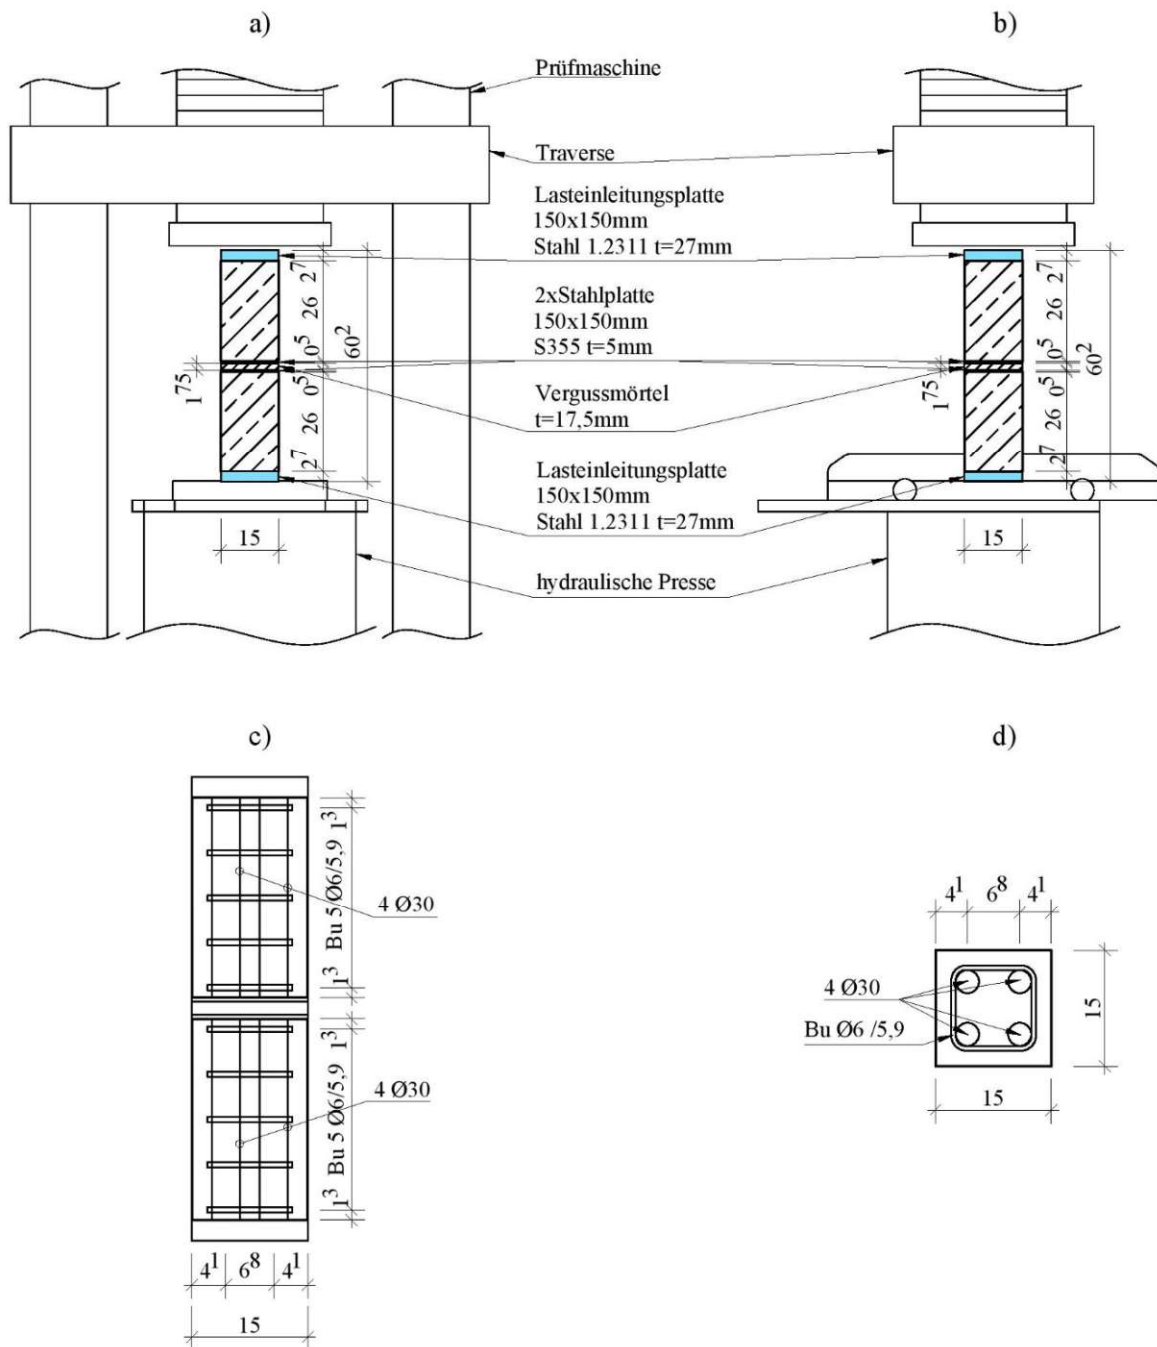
Stütze mit Stumpfstoß a) Ansicht von vorne, b) Seitenansicht, c) Bewehrung im Aufriss, d) Bewehrung im Grundriss
